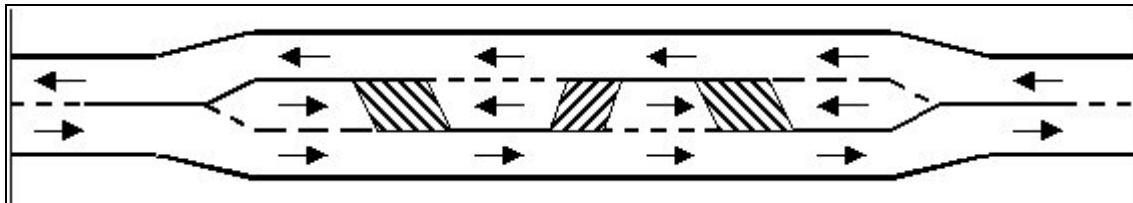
Prinzipdarstellung eines RQ 15,5 im Lageplan
